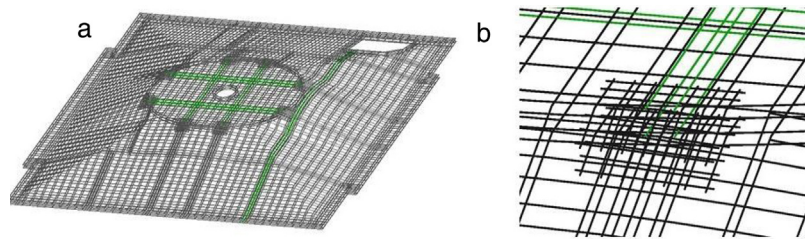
Losa reticular. a) Parrilla del armado de la losa; b) detalle del armado en los capiteles.
